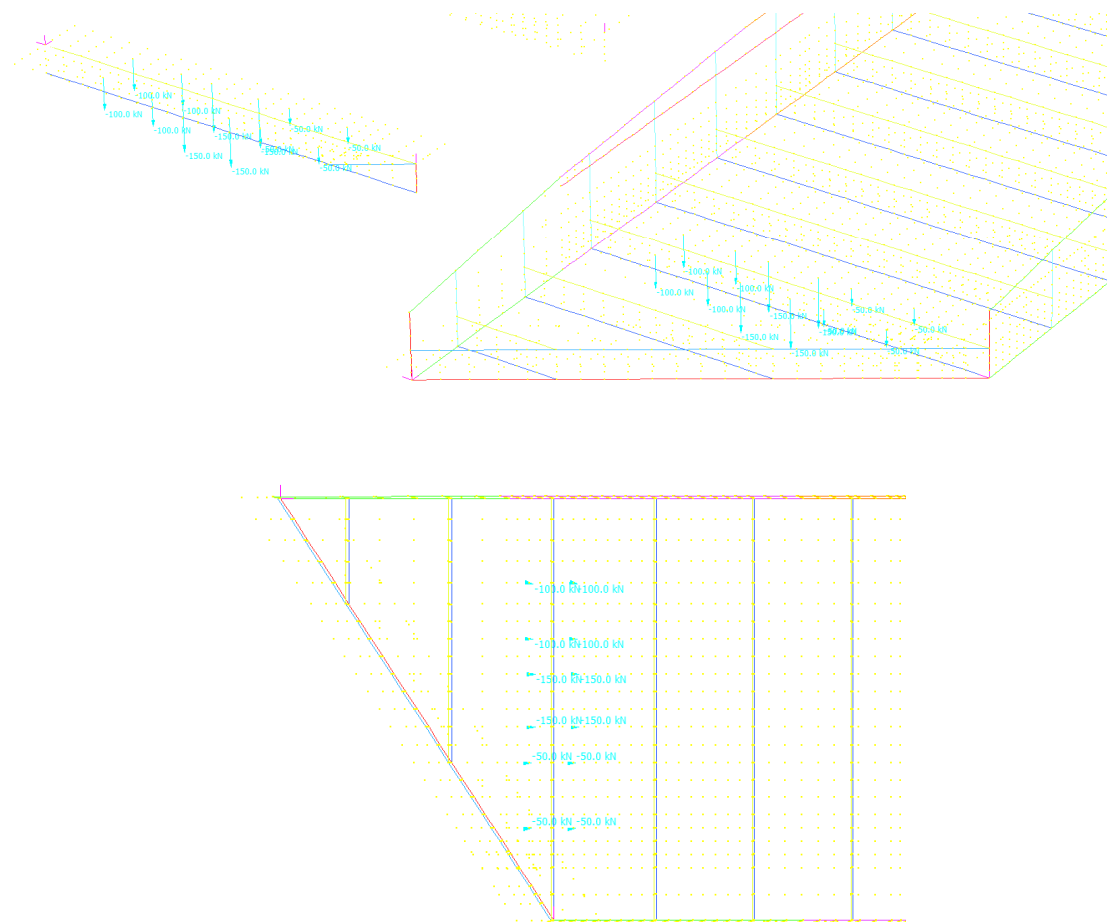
Modello tridimensionale dell'intero impalcato. Vista 3D e planimetria della disposizione dei carichi
